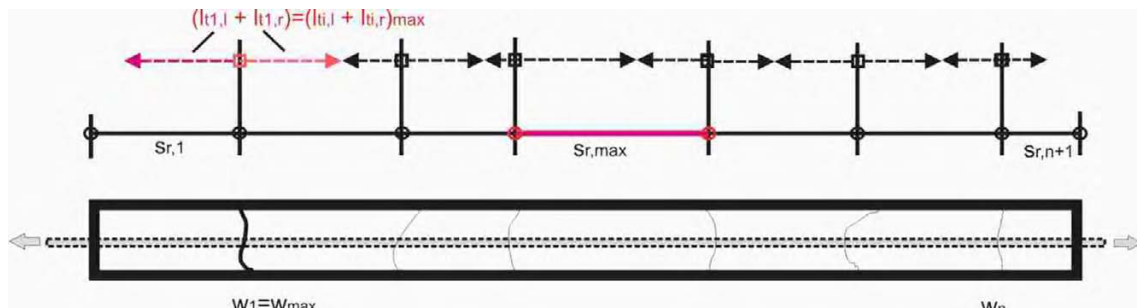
Darstellung großer Rissbreiten, Rissabstände und Summen der beteiligten Einleitungslängen
